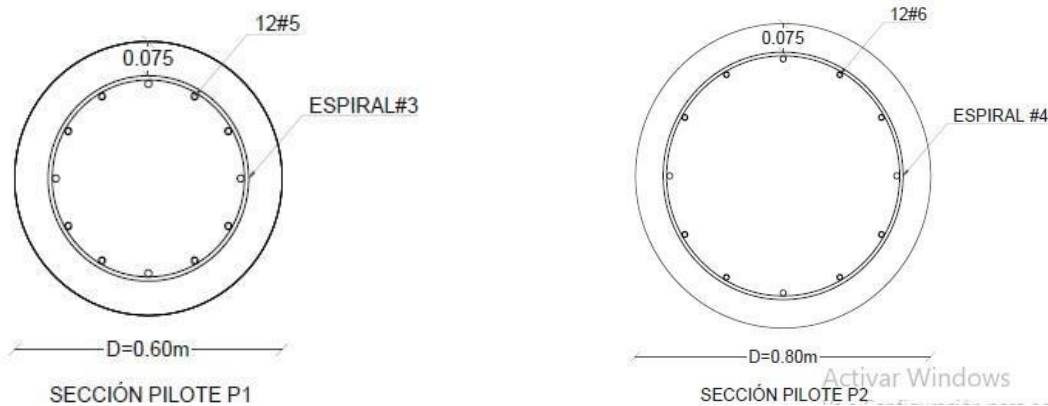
Despiece de acero de pilotes, P1 y P2
